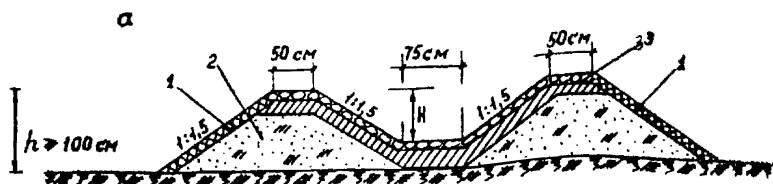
Конструкции элементов водоотводных сетей на вечномёрзлых грунтах:
